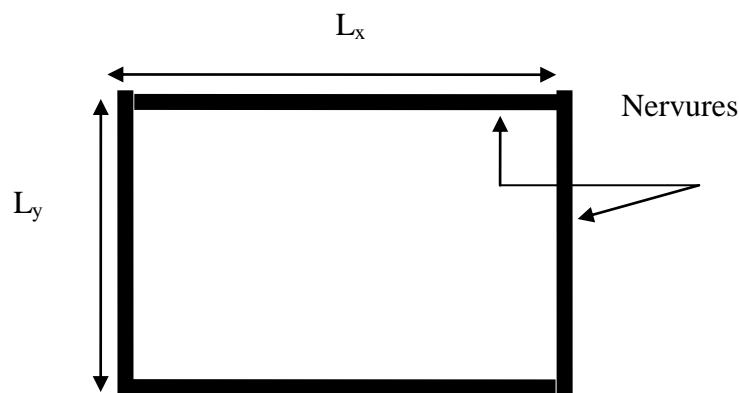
Schéma d'une dalle sur quatre appuis
